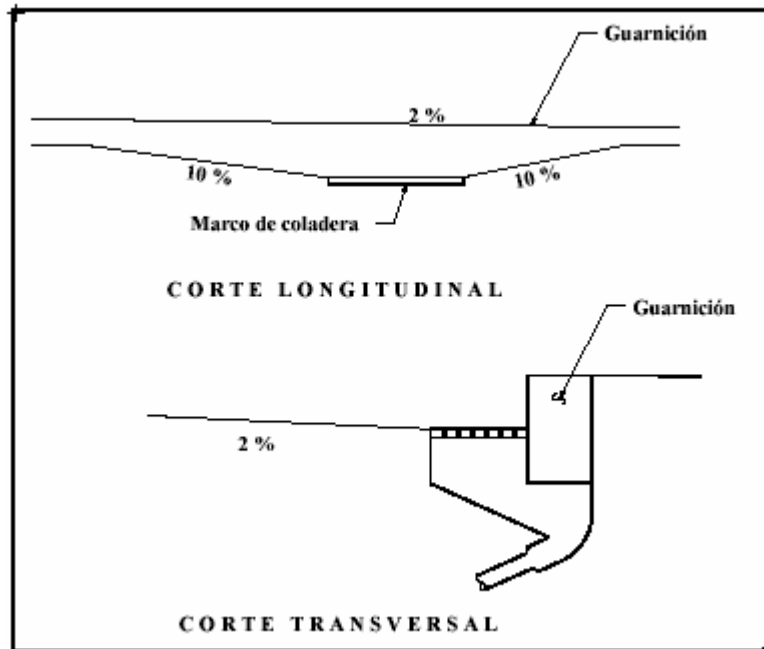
Cortes longitudinal y transversal de un pavimento con pendientes hacia la coladera de piso.
